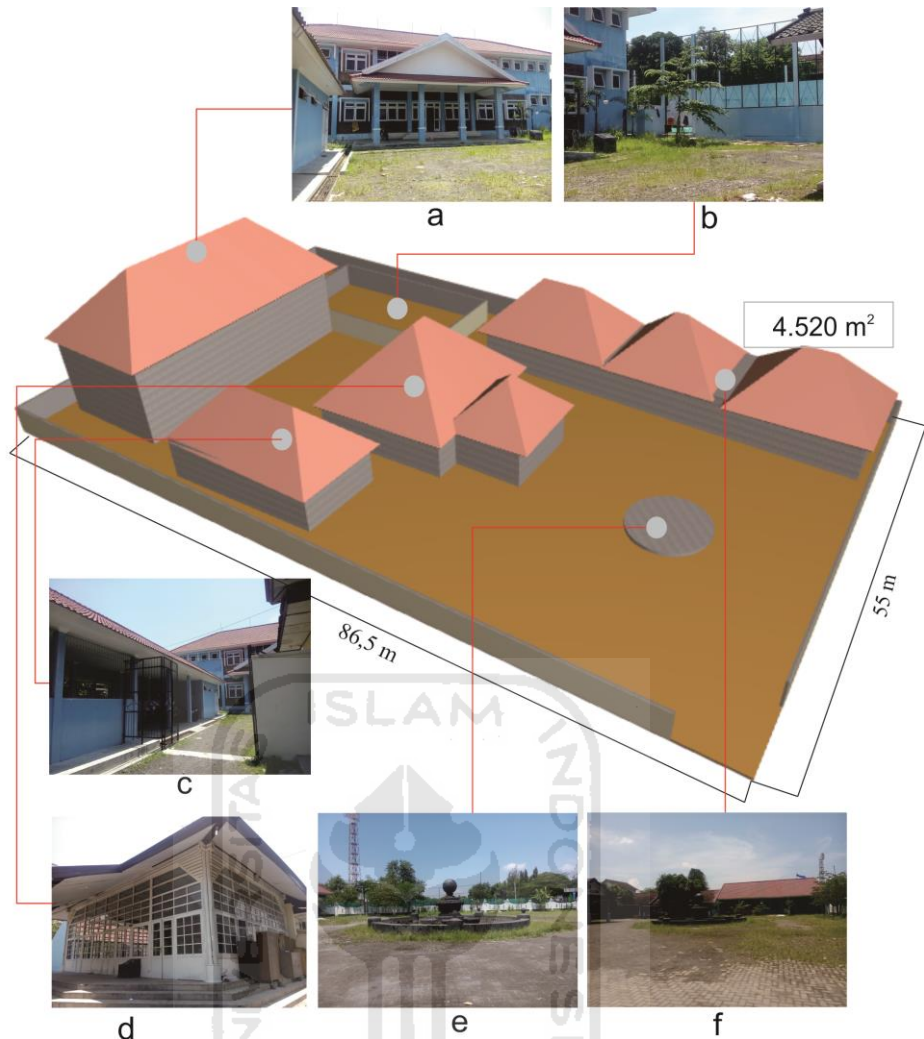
Peta Lokasi Site (a) Foto Site (b)
